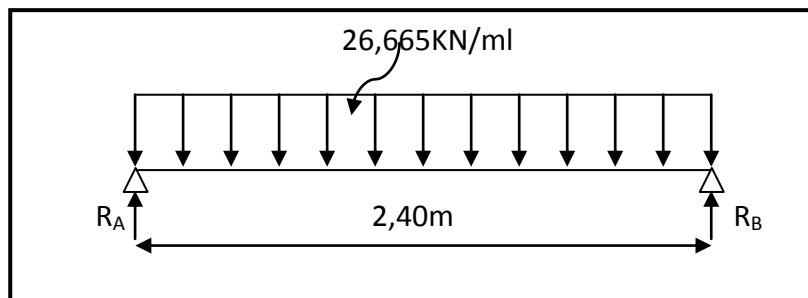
Schéma statique de la poutre palière à l'ELS.
